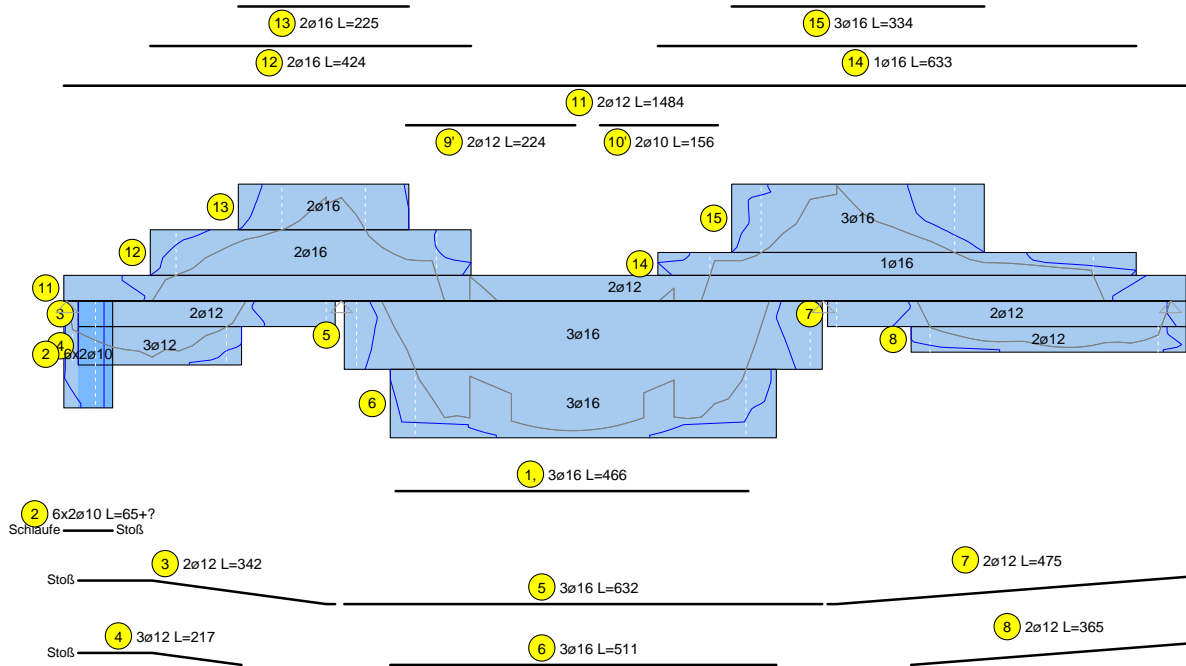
Konstruierte Längsbewehrung. Maßstab 1 : 100, 1cm = 6,67cm<sup>2</sup>.
